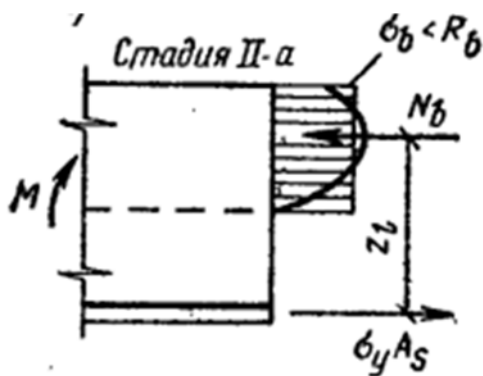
Схема усилий в бетоне и арматуре в зоне пластического шарнира
